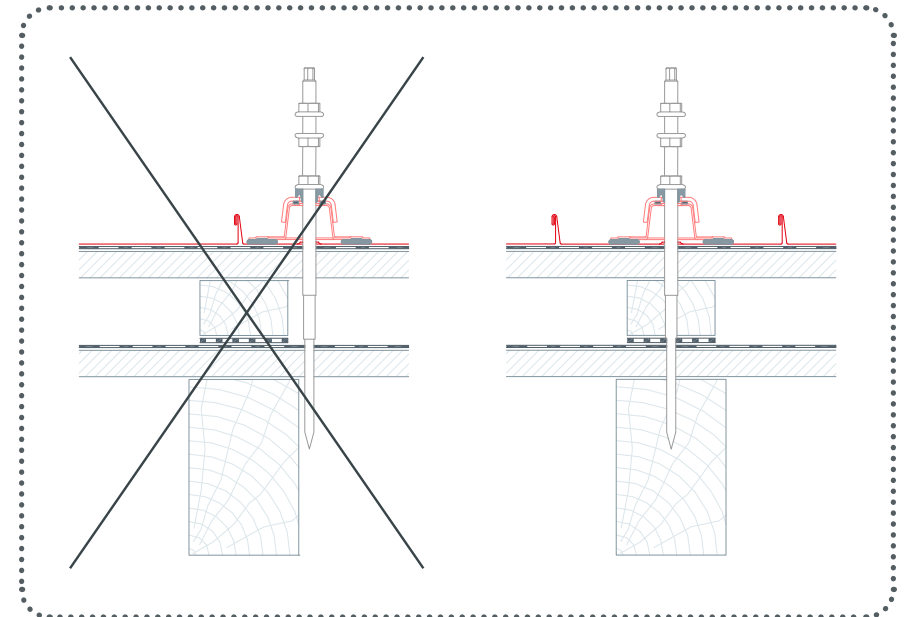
· Sondermaßnahme bei zweischaliger Dachkonstruktion
